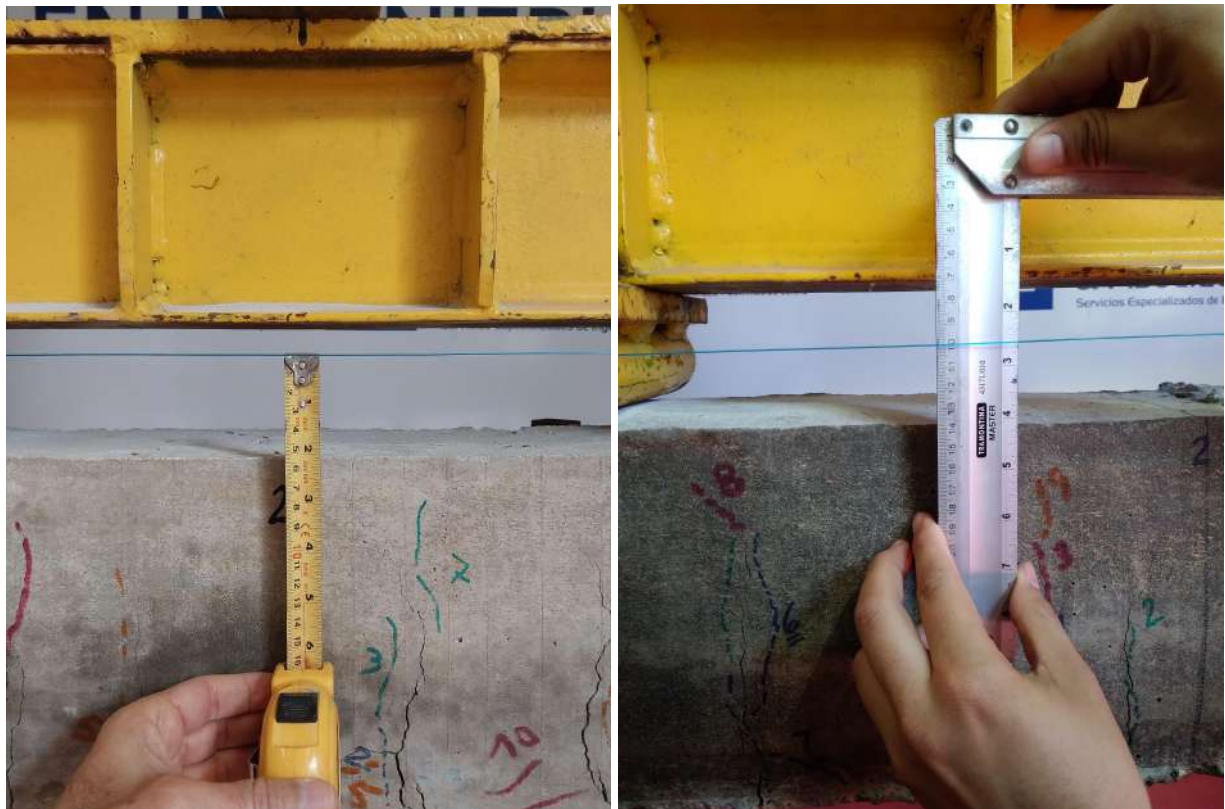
Esquema de fisuras en viga con refuerzo de acero.
